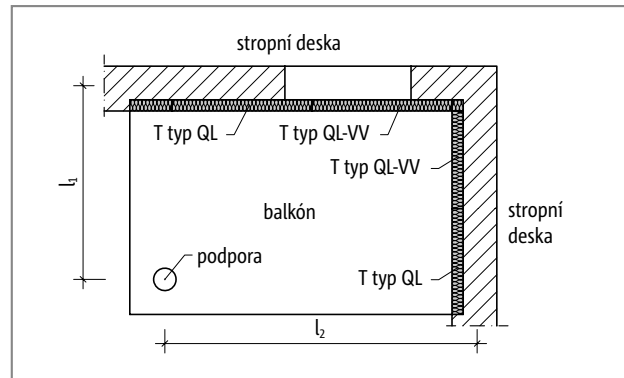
Schöck Isokorb® T typ QL: Balkón se sloupovými podporami
